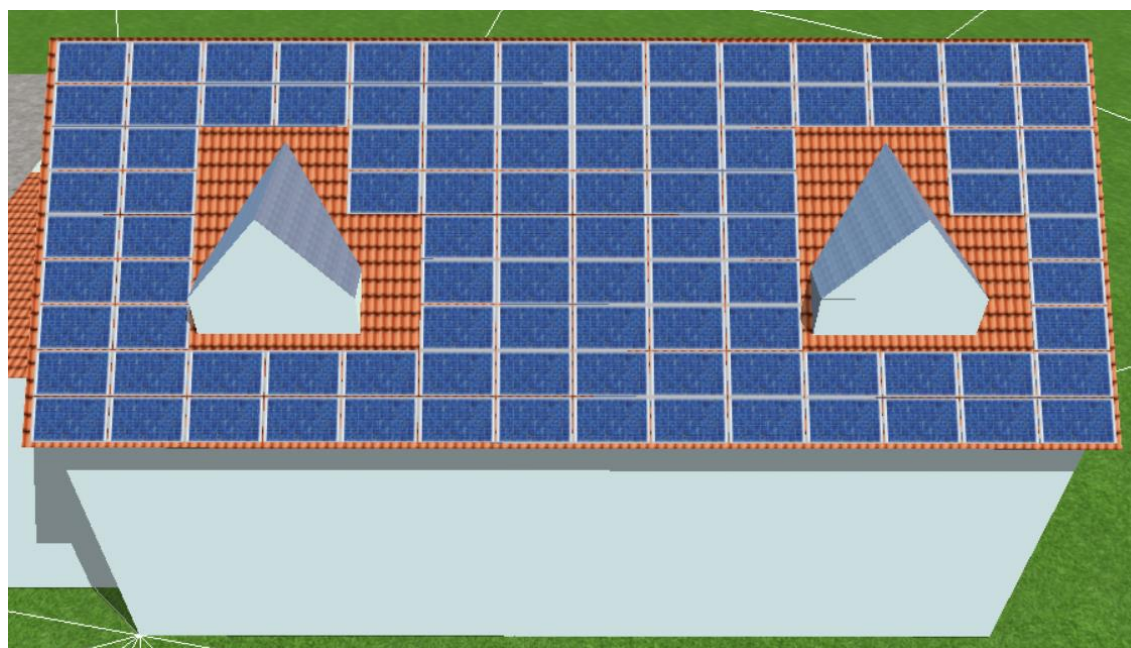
Variante Zubau 20 kWp auf dem Altbaudach
